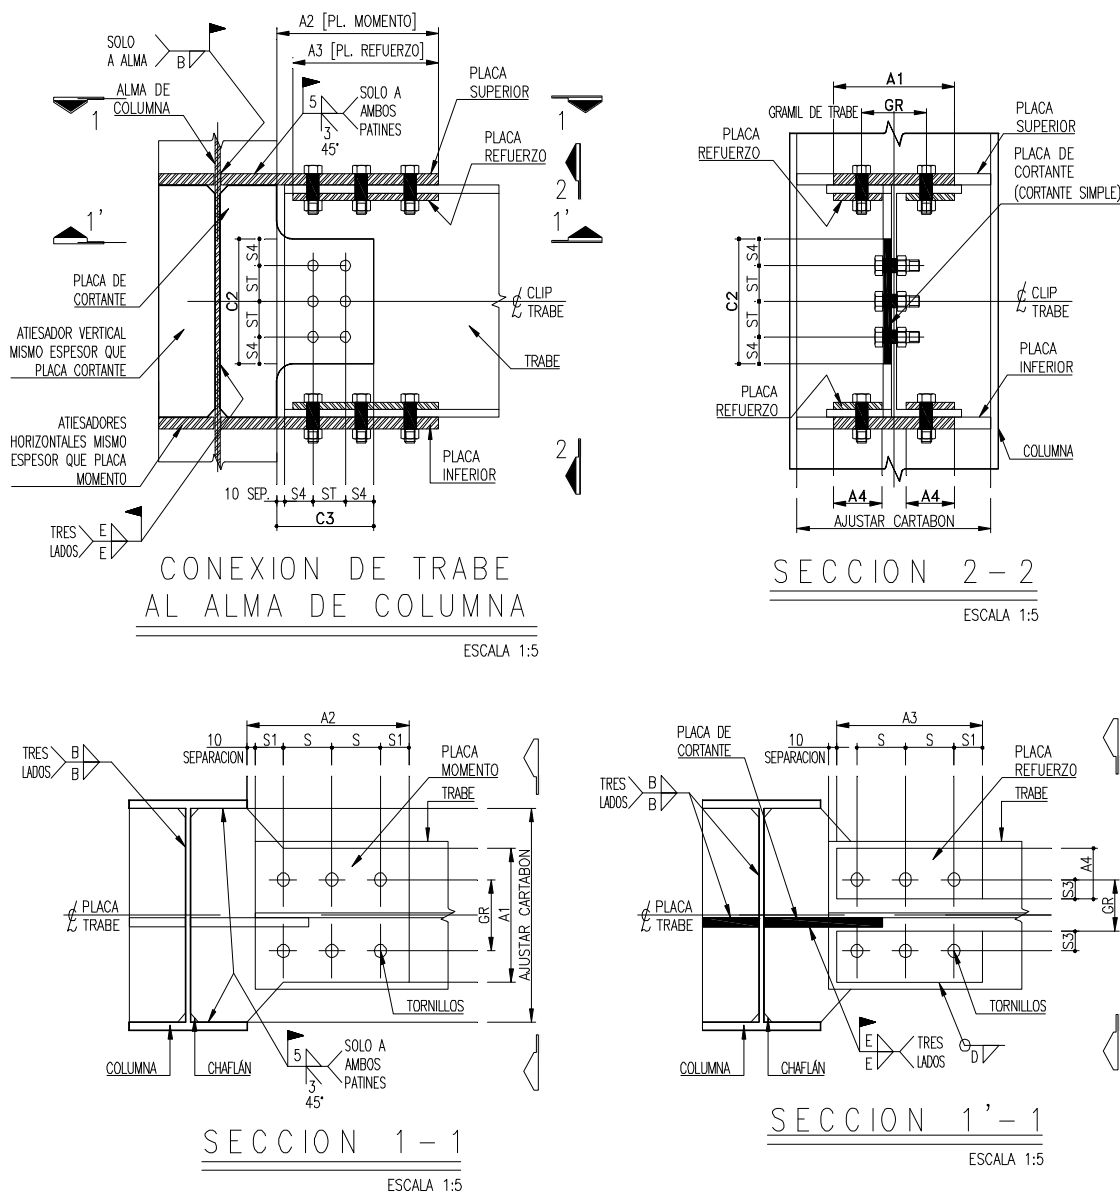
Detalle de conexión rígida de viga en alma de columna IR (típica en México).
